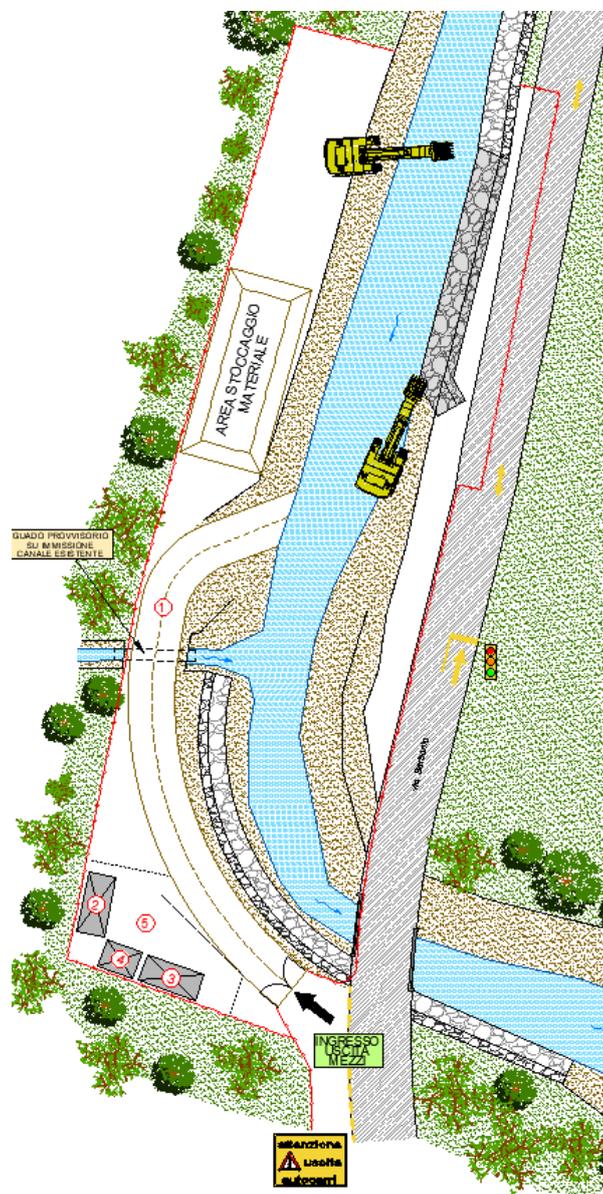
Estratto della Planimetria di cantierizzazione per l’intervento di monte.
